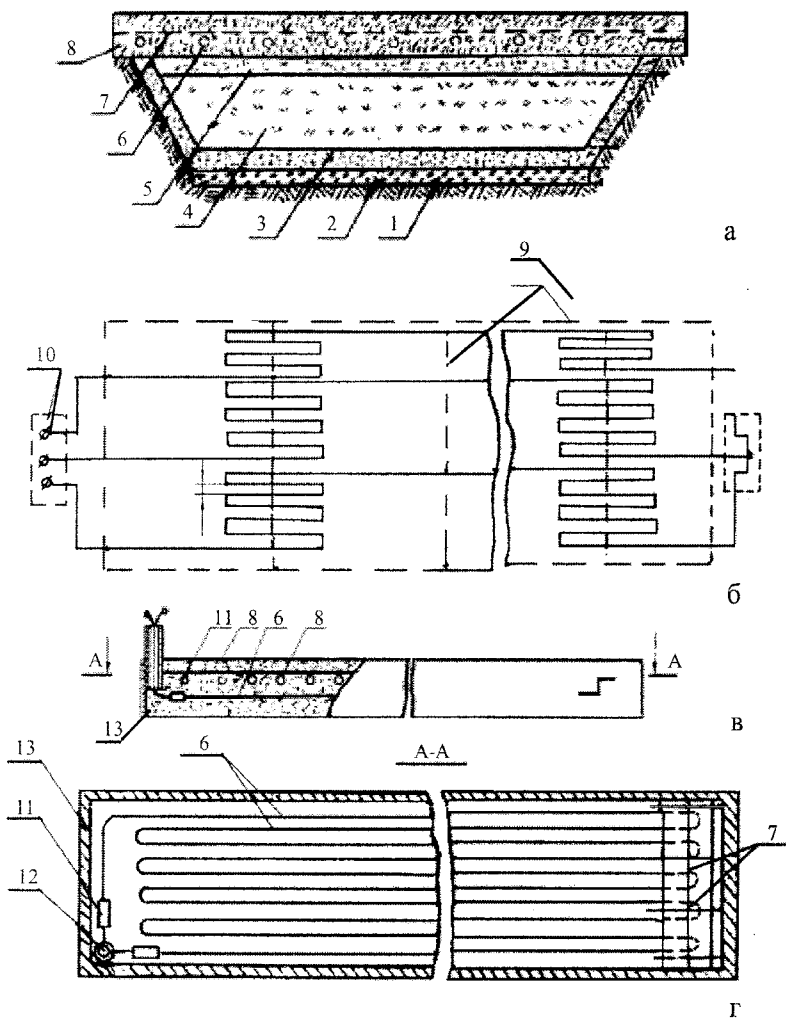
Поперечные разрезы и планы электрообогреваемых пола (а, б) и бетонной плиты (в, г): 1 – грунт; 2 – бетонная стяжка; 3 – гидроизоляция (рубероид); 4 – теплоизоляция (шлак); 5 – песок; 6 – провод нагревательный; 7 – сетка металлическая; 8 – бетон; 9 – ограждения станка для животных; 10 – коробка подключений; 11 – узел соединения токопроводящего и нагревательного проводов; 12 – труба стальная; 13 – каркас металлический
